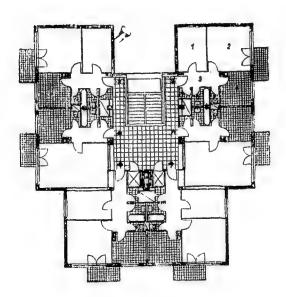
٩ - ٢ : مسقط أفقى للدور المتكرر
